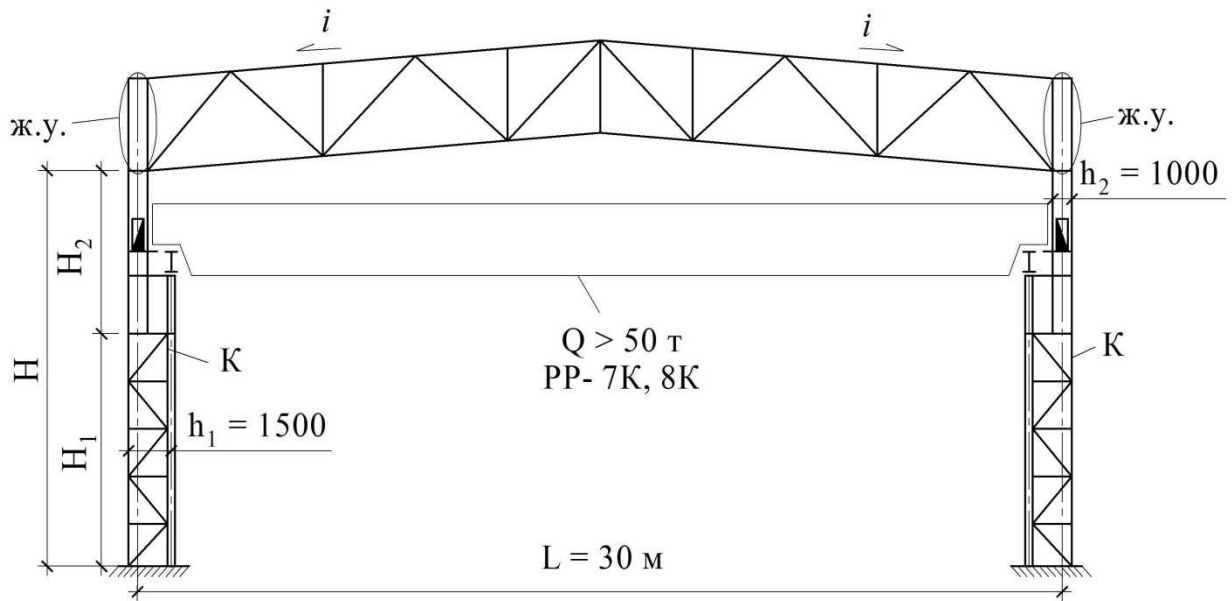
Однопролетная поперечная рама с верхними жесткими узлами и мостовыми кранами тяжелого (7К) и весьма тяжелого (8К) режимов работы со ступенчатыми колоннами, нижние участки сквозного сечения
